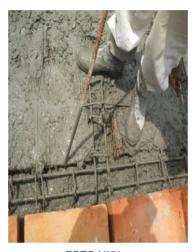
VARILLADO DE VIGAS PRINCIPALES DE ENTREPISO
